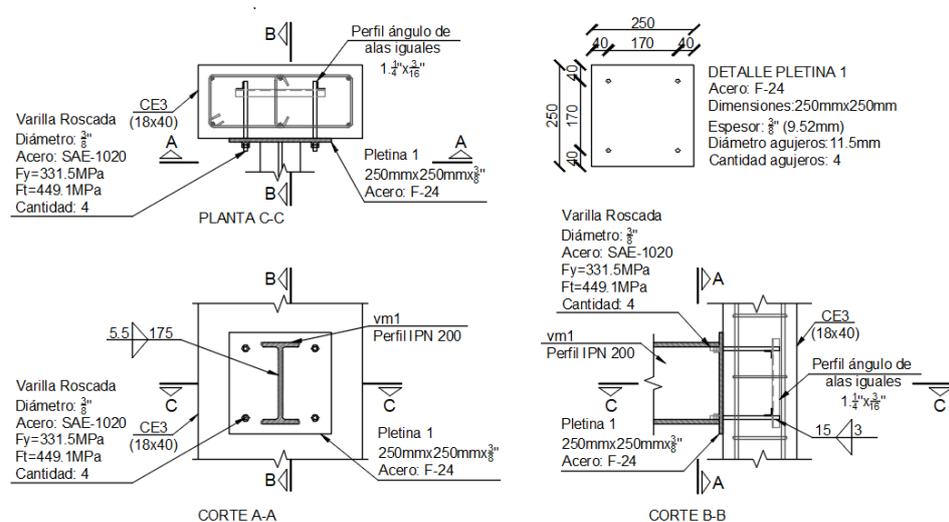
Detalle 1: unión perfil metálico con columna de H<sup>A</sup>
